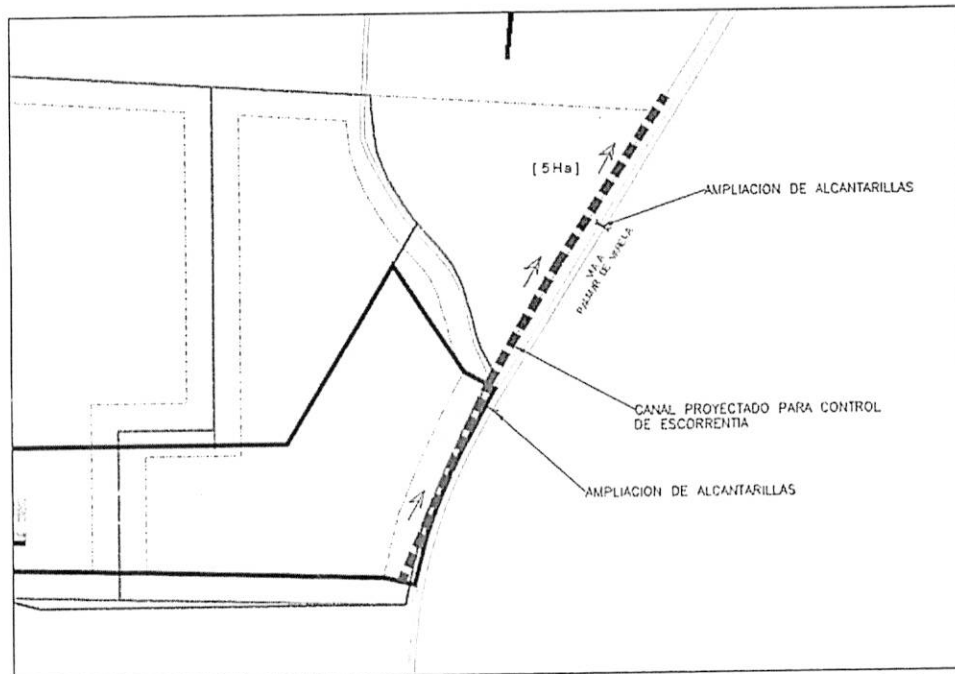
Esquema de control de escorrentía en la parte baja del lote (sector oriental) del lote.
